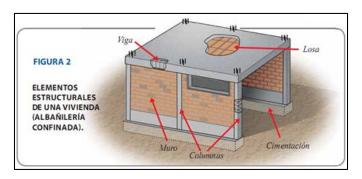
Esquema de una vivienda con sus elementos estructurales principales.
